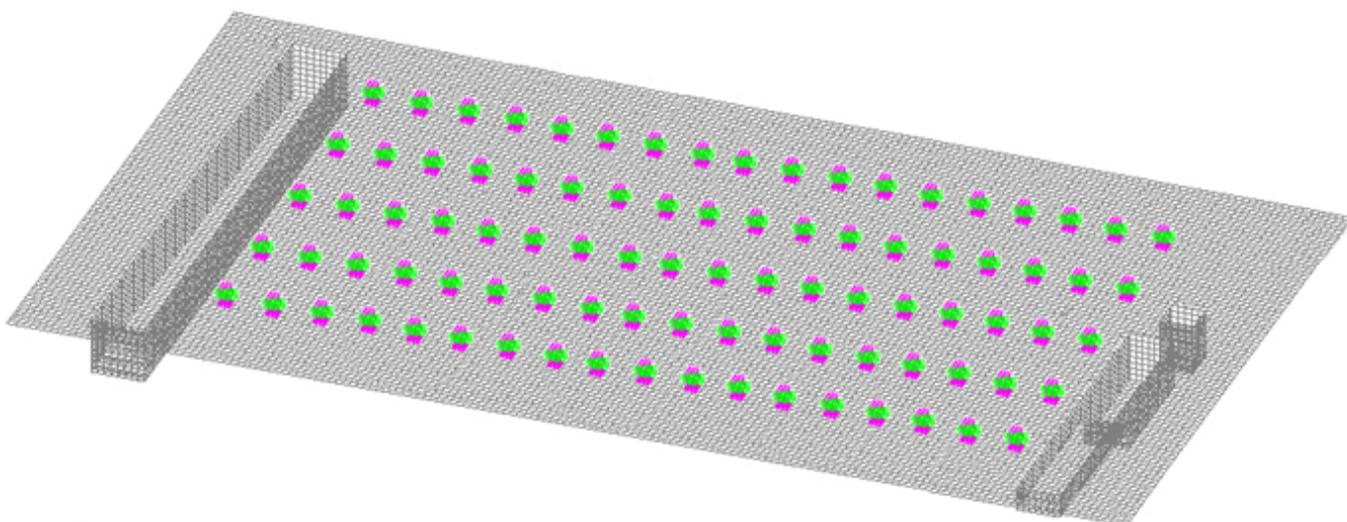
нагрузки на фундамент от каркаса здания
